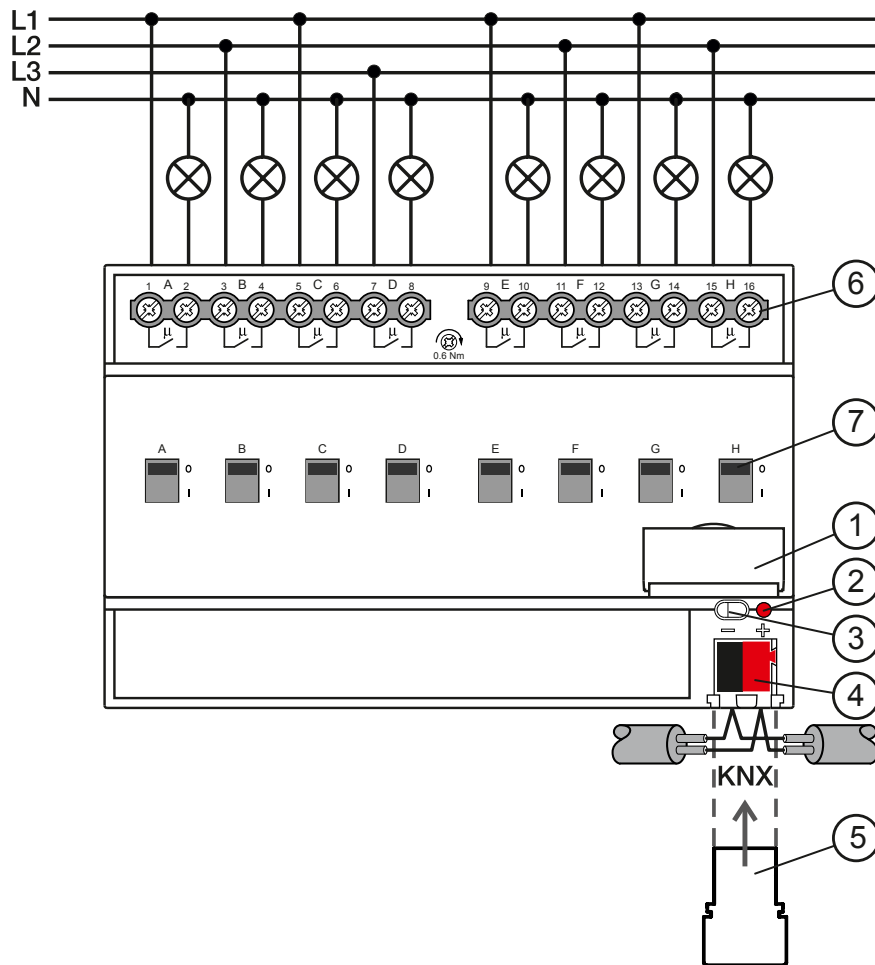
Schema di collegamento SA/S 8.x.x.2
